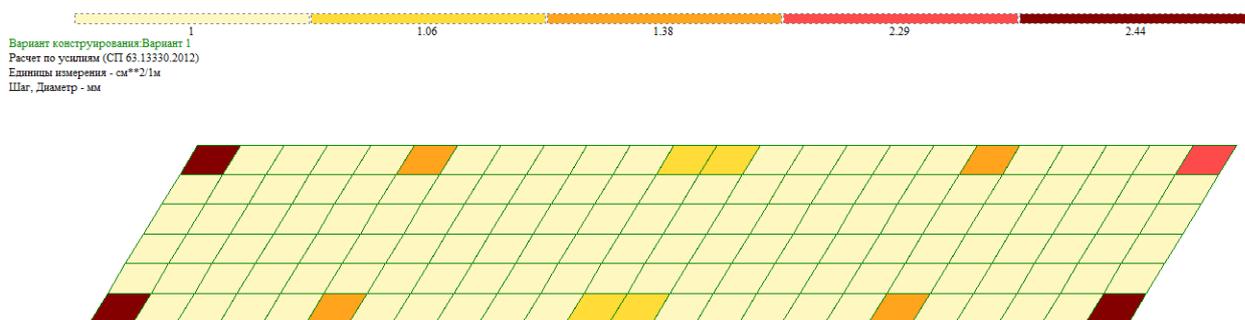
Расчет нижней арматуры по ОУ
